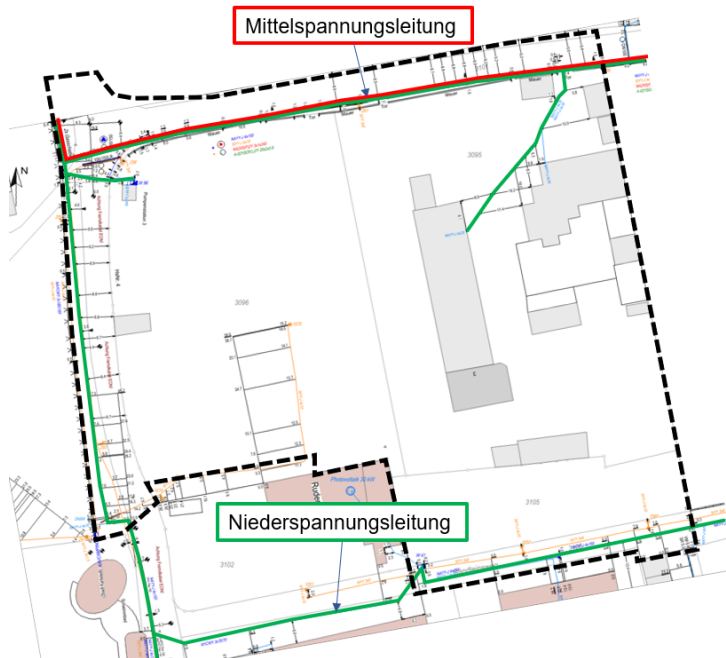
Lageplan örtliches Stromnetz (Stadtwerk Karlstadt)
